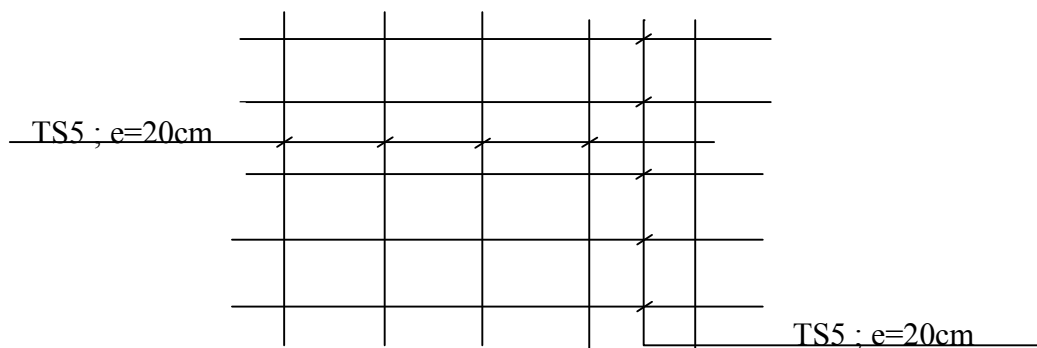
schéma de ferrailage de la dalle de compression.
